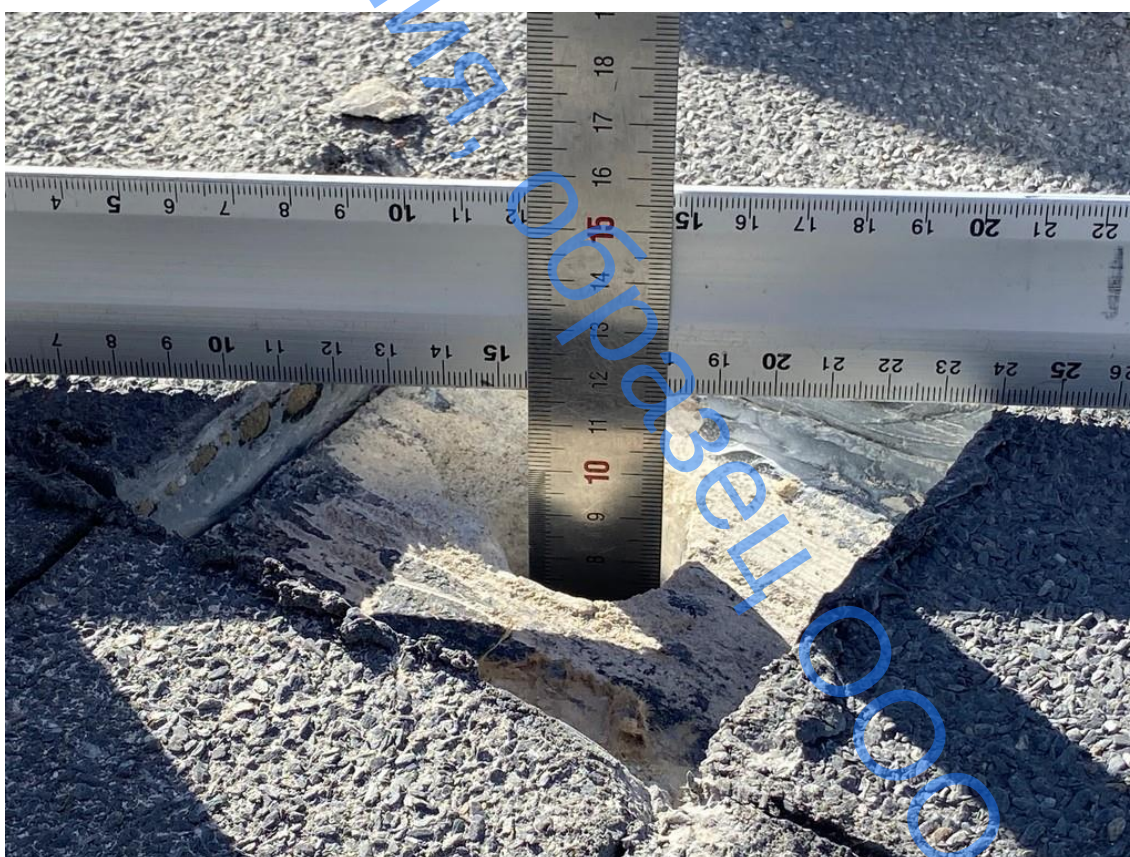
Вскрытие кровли №1 (толщина стяжки 88 мм)
